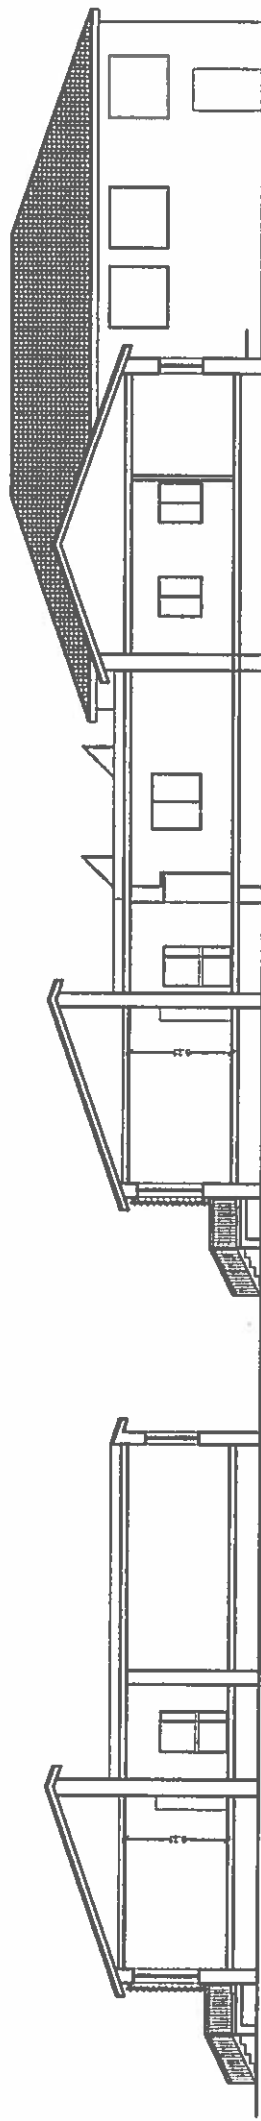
VISTA SUD EST ZONA INGRESSO "A"
